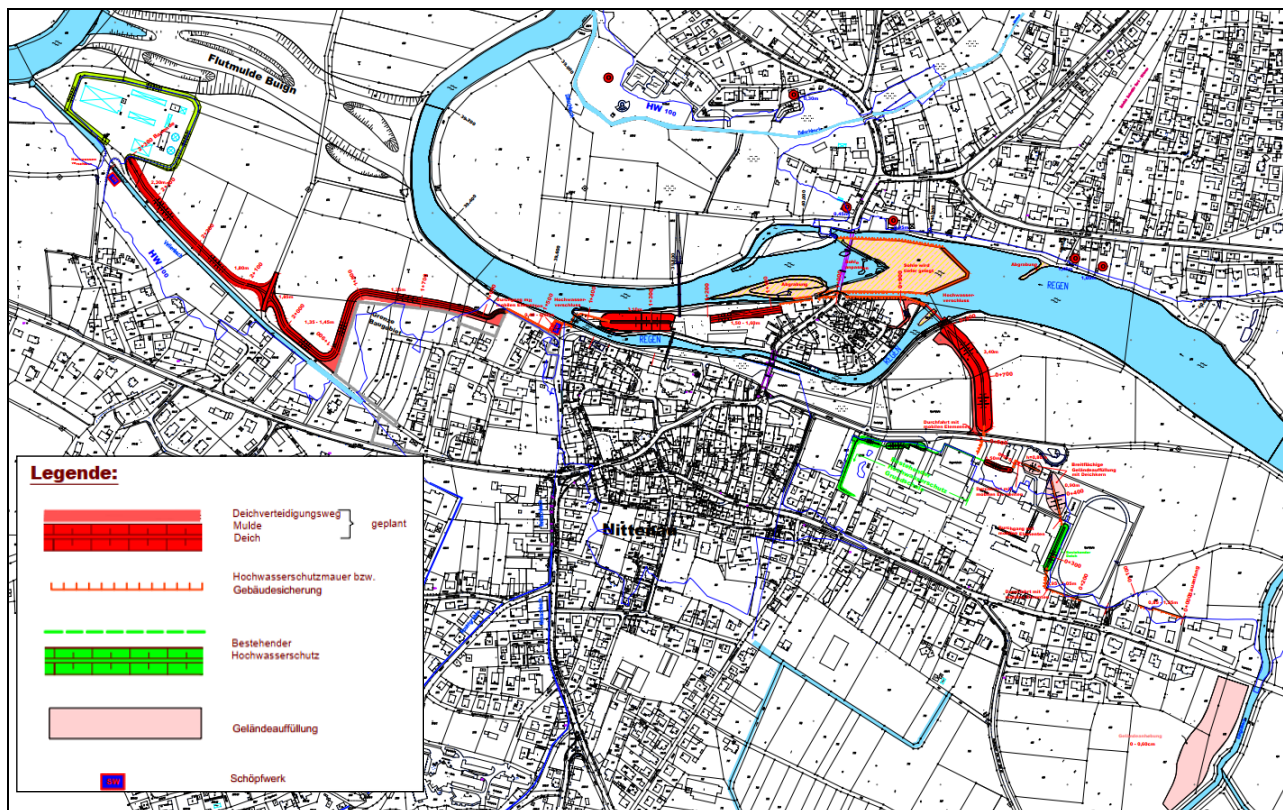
Lageplan Variante 2b2 (Quelle: WWA 2013, Plan-Nr. 2.4)
